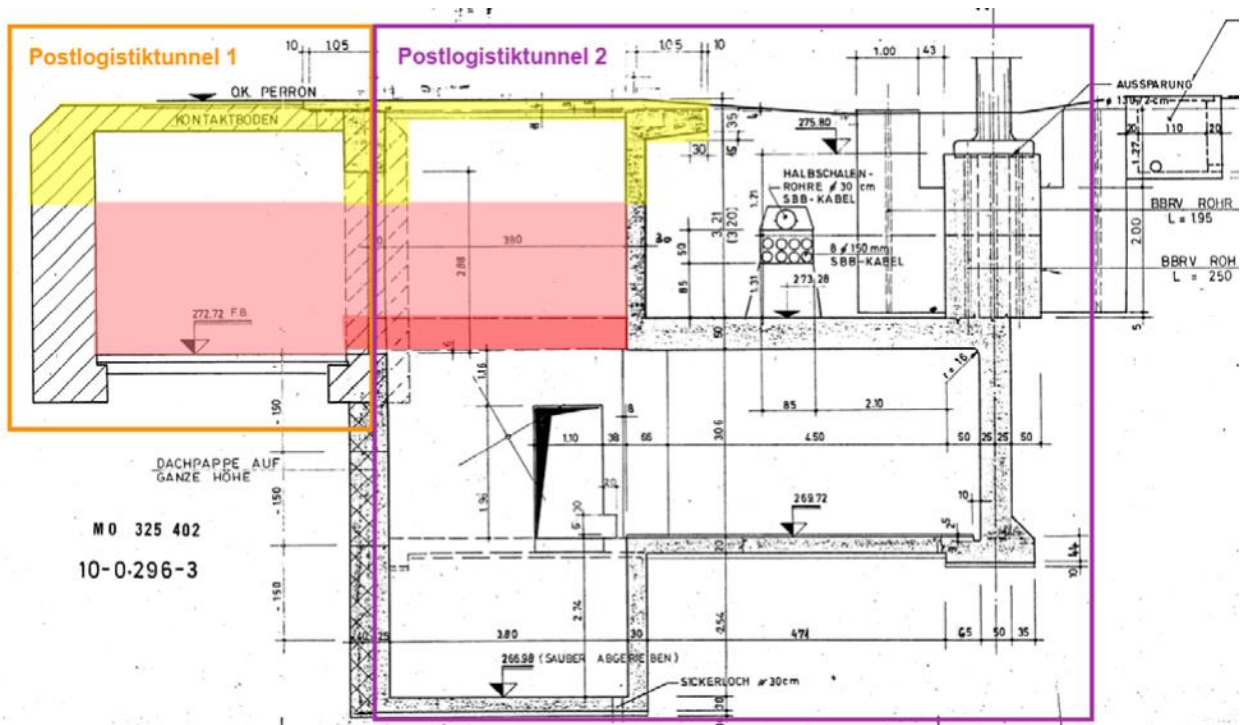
Schnitt durch Postlogistiktunnel 1 und 2 im Perronbereich mit Teilabbruch (gelb), neuer Betondecke (rot) und Auffüllung (hellrot)
